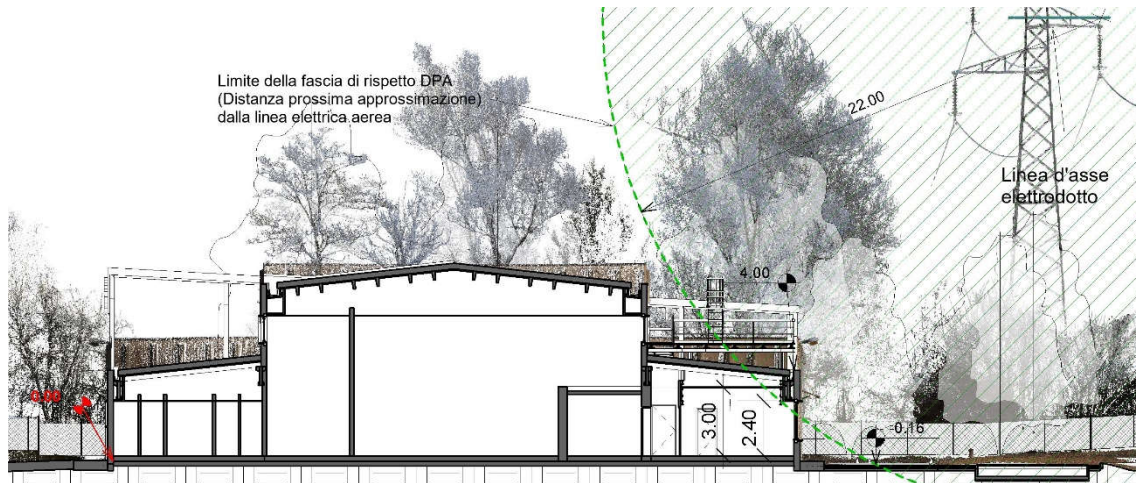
Sezione trasversale dell'edificio - Limite della fascia di rispetto DPA
